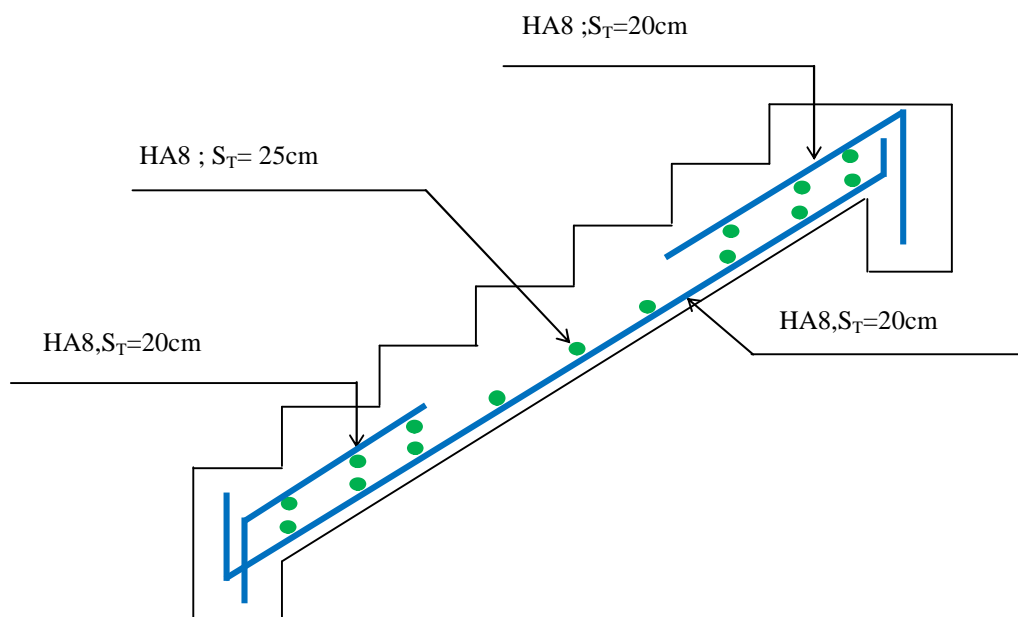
Schéma de ferrailage de l'escalier type 1.
